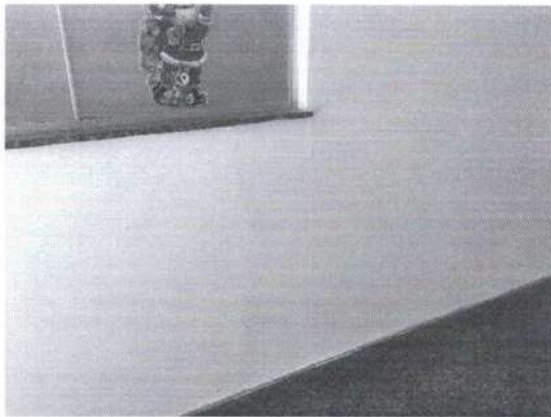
Trinca localizada na parede – trechos de alvenarias tratados
